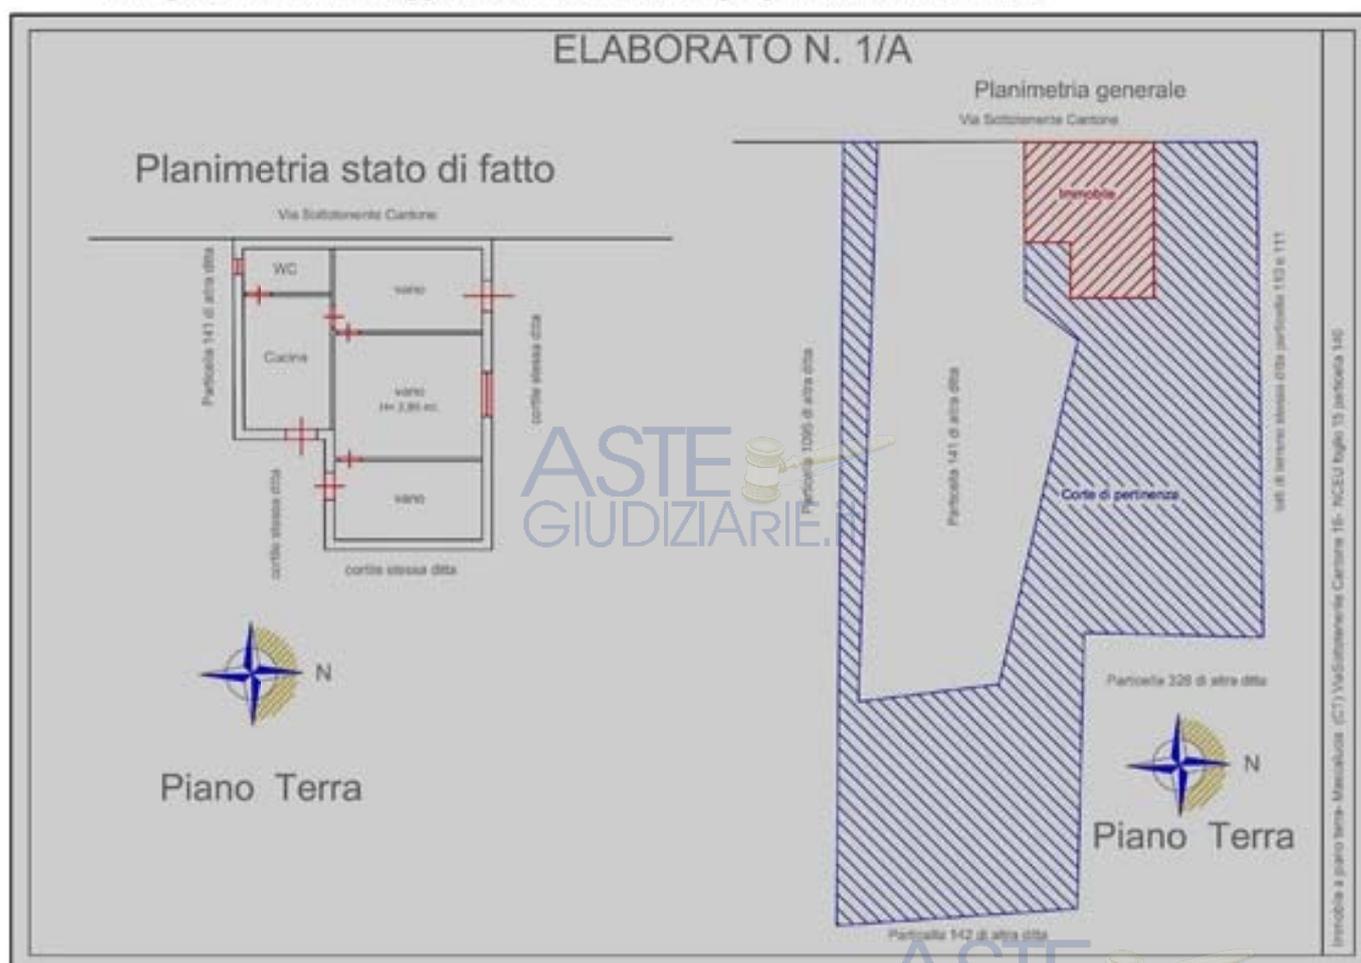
Visualizzazione della planimetria reale dell'immobile ed individuazione della sua corte
